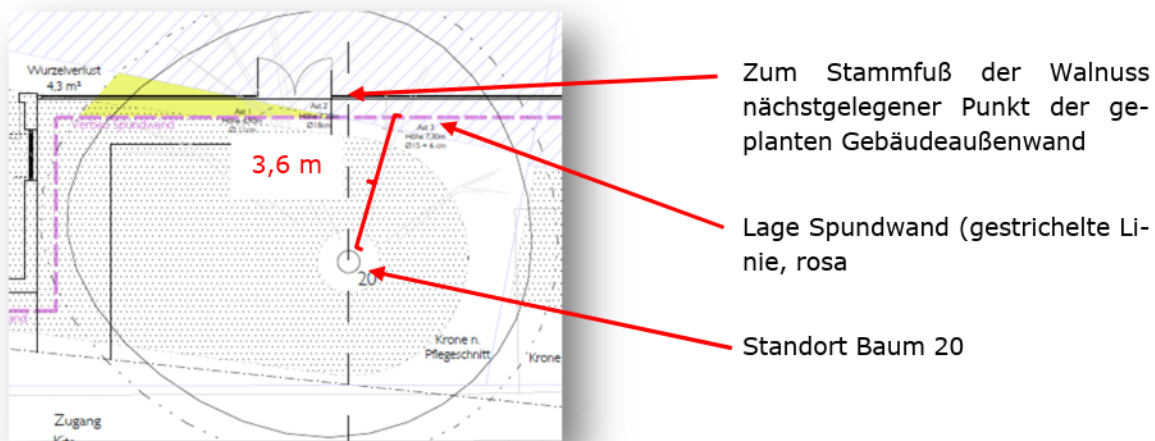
Ausschnitt aus dem Baumbestandsplan
